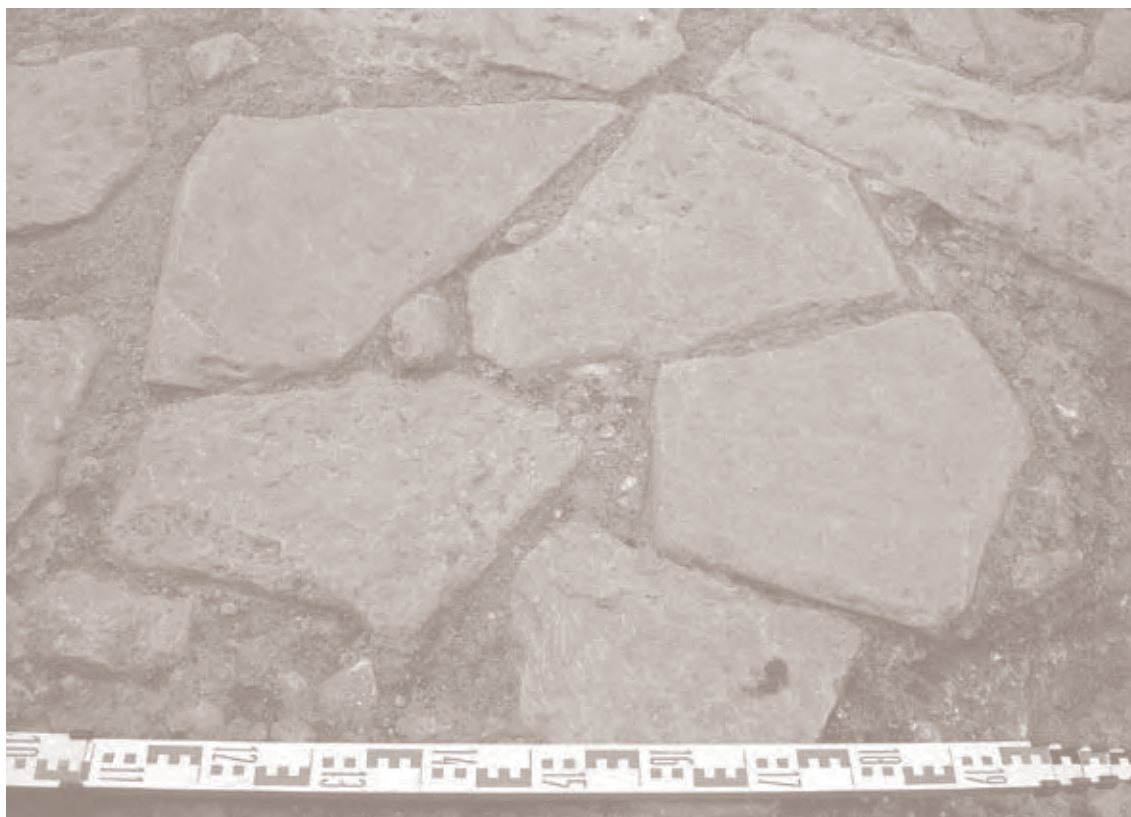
Fotografia de pormenor do pavimento lajeado UE [93].
